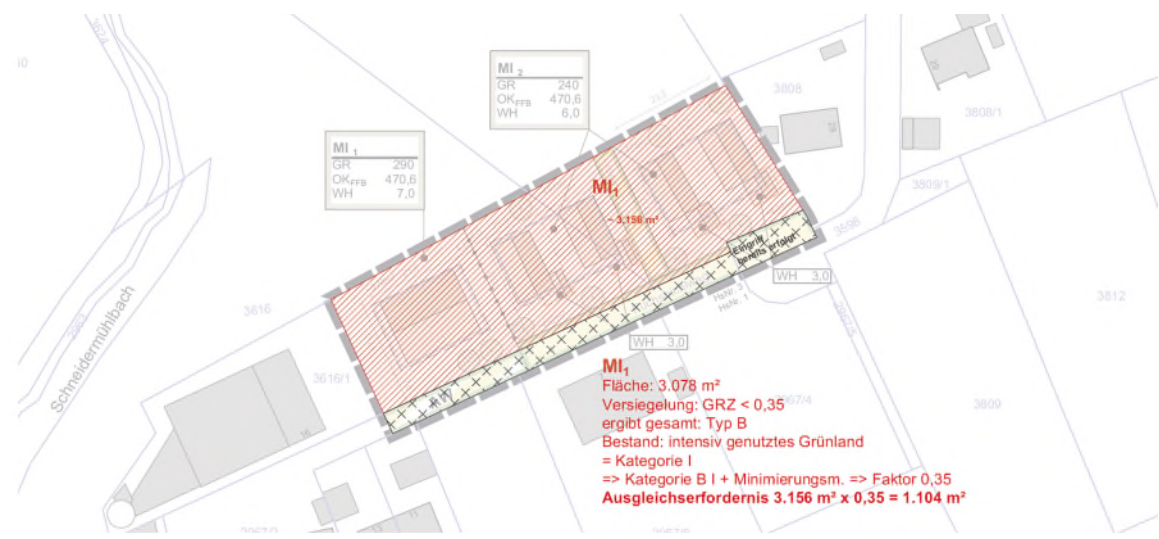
Übersichtsplan Ausgleichsermittlung, 15. Änderung des Ur-Bebauungsplans Nr. 40 - ohne Maßstab
